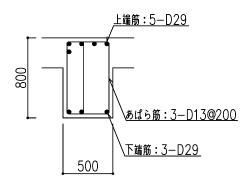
大ばりの配筋図 (屋上階, X3 通り YD~YE 通り間, 端部) (単位:mm)
